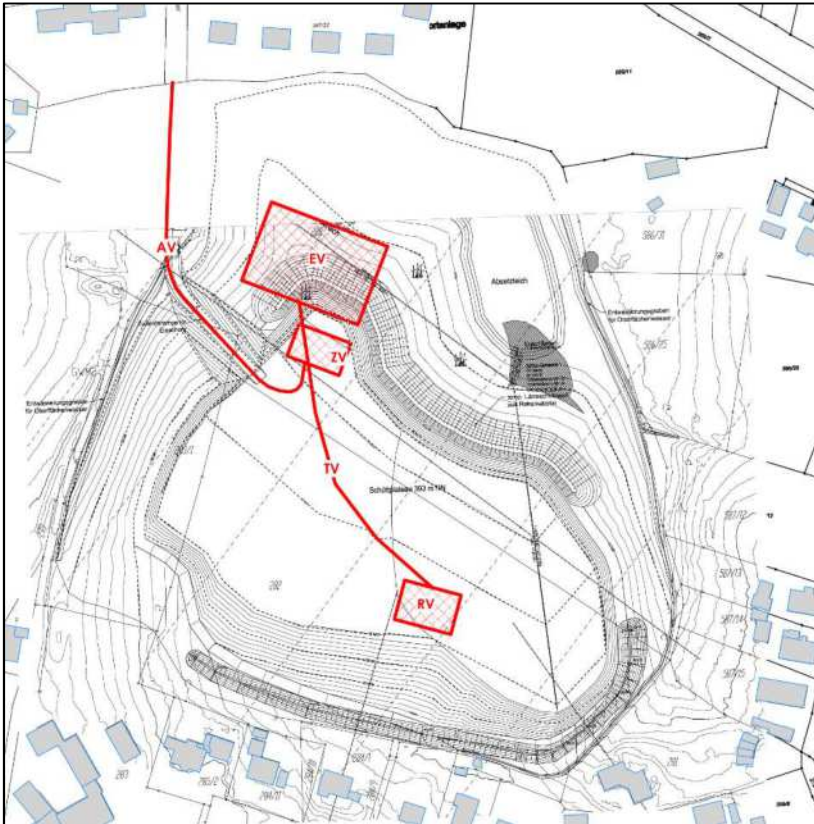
Lageplan mit Darstellung der relevanten Schallquellen – Variante 1
